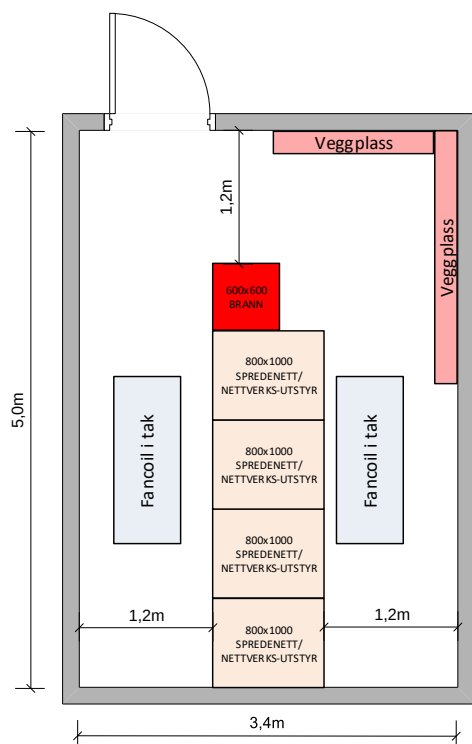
FORESLÅTT CA. PLASSERING AV KR PLAN 5 -7
